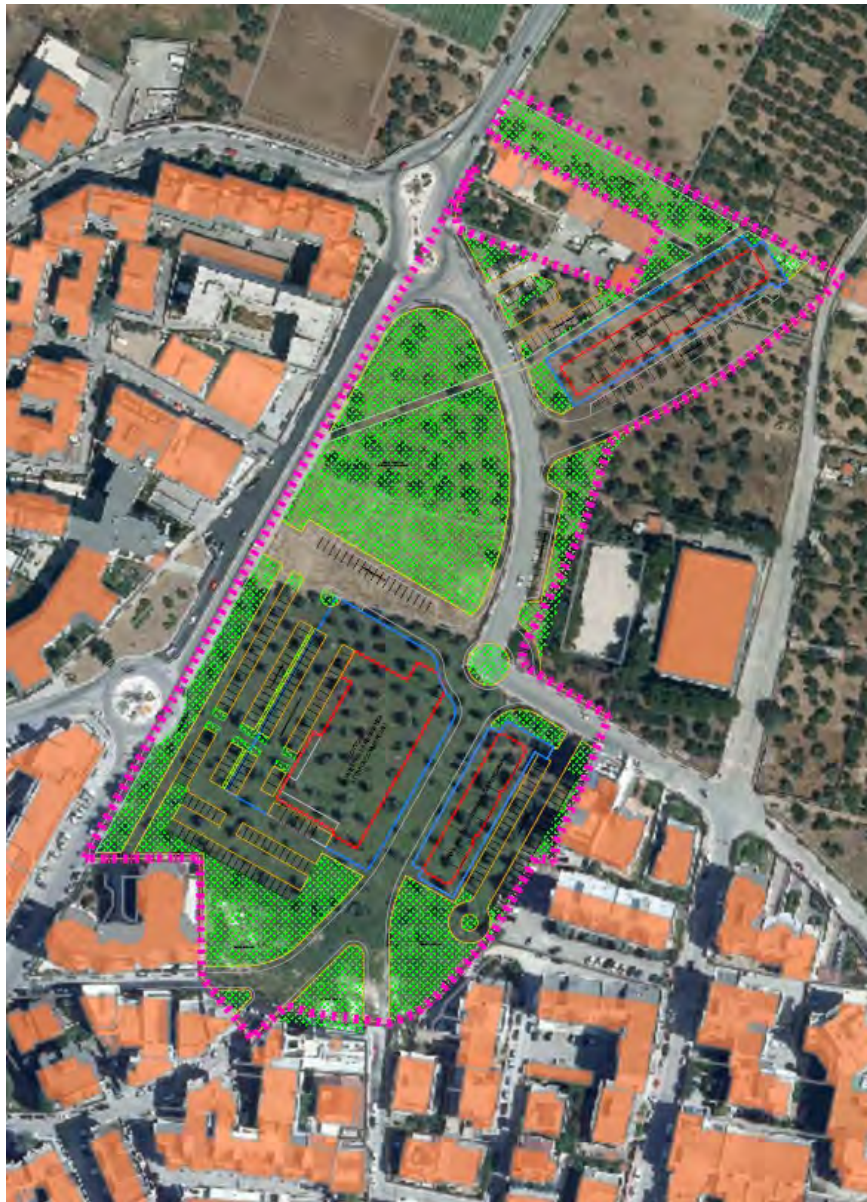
Sovrapposizione del Piano con l'Ortofoto
